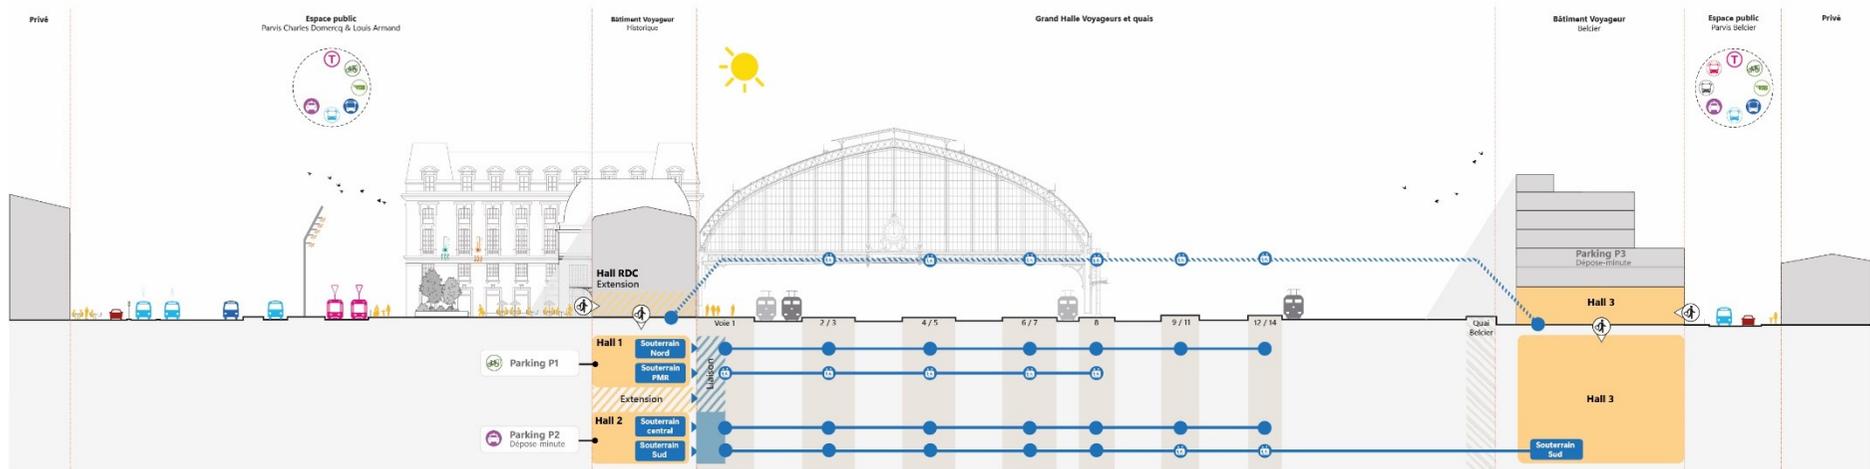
Perspective d'un plan en coupe du projet de désaturation de la gare ferroviaire de Bordeaux Saint Jean (AREP/SNCF)
